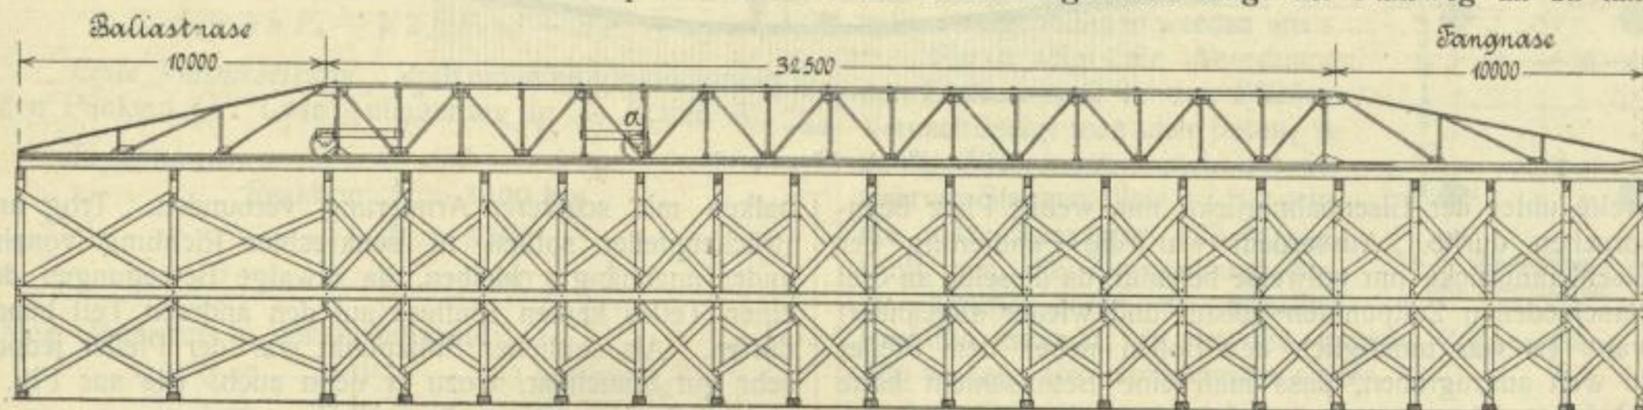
Personenbrücke für das Eisenbahngelände in Utrecht auf dem Gerüst.
